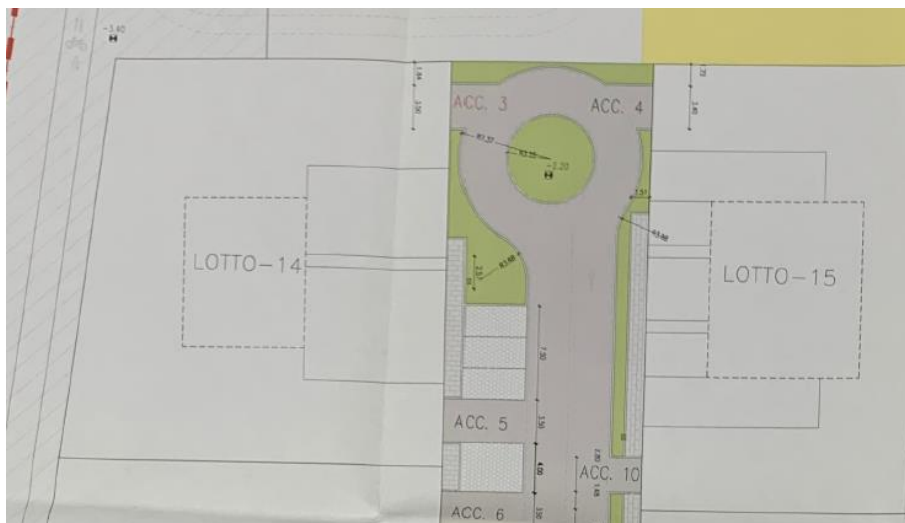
Estratto planimetria progetto esecutivo comparto C5/7 – Stato di fatto
